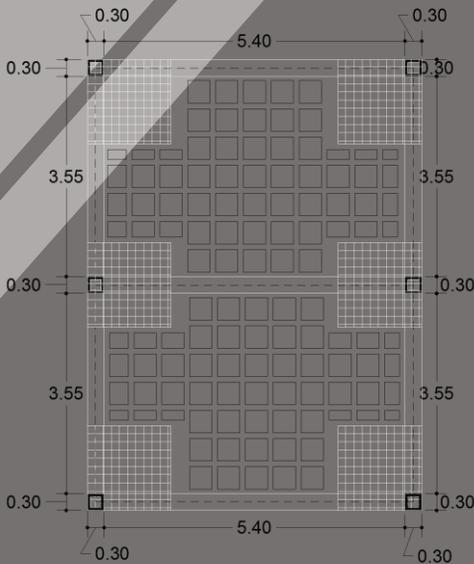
Losa de entrepiso (reticular) de Aula Taller de CDC Aciuitzio. Fuente: Elaboración Propia.
